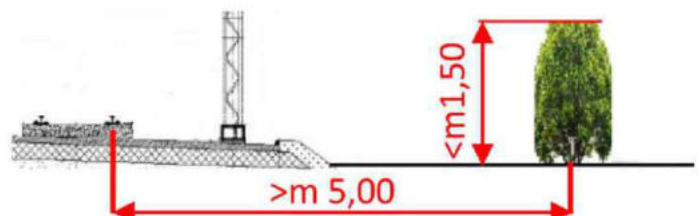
Distanza minima che deve esserci tra piante, siepi, muretti di cinta, steccati o recinzioni dalla rotaia più vicina se l'altezza di questi è inferiore a m 1,50
